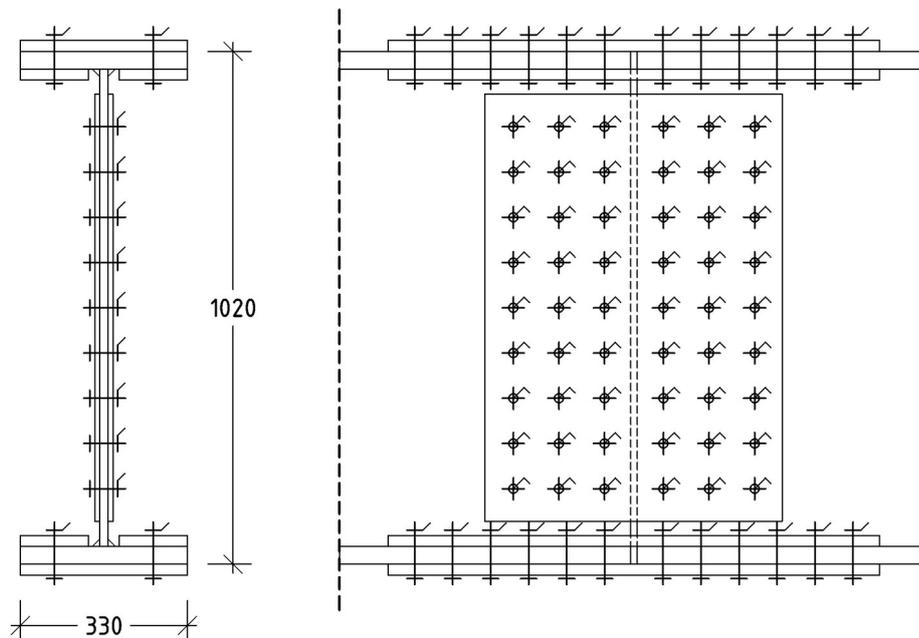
Laschenstoß zweier geschweißter Stahlträger
